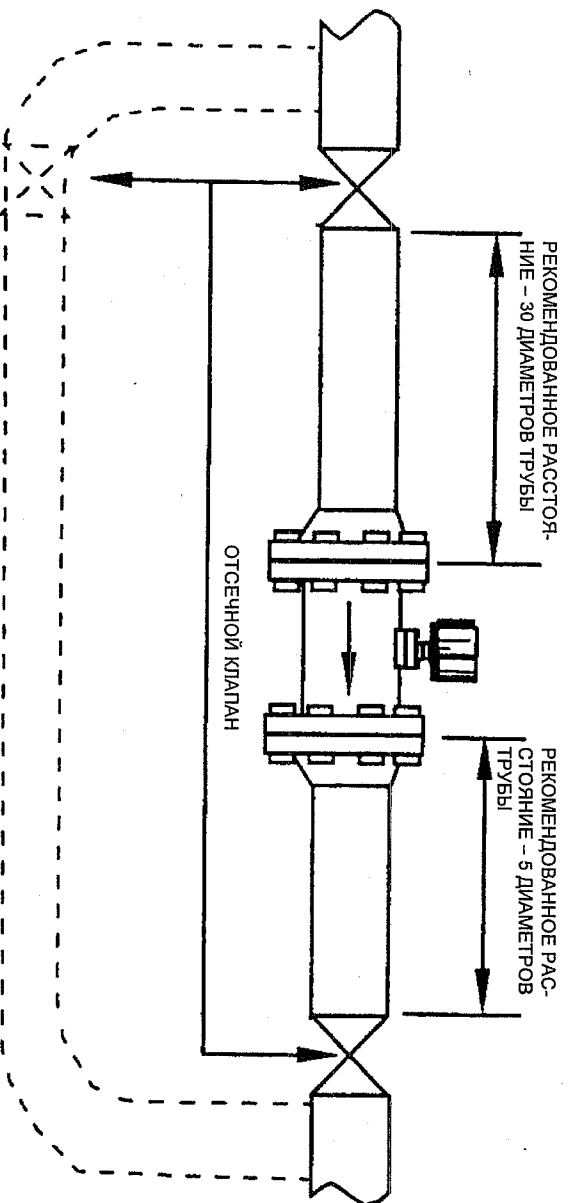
Типовая схема монтажа расходомера на трубопроводе
